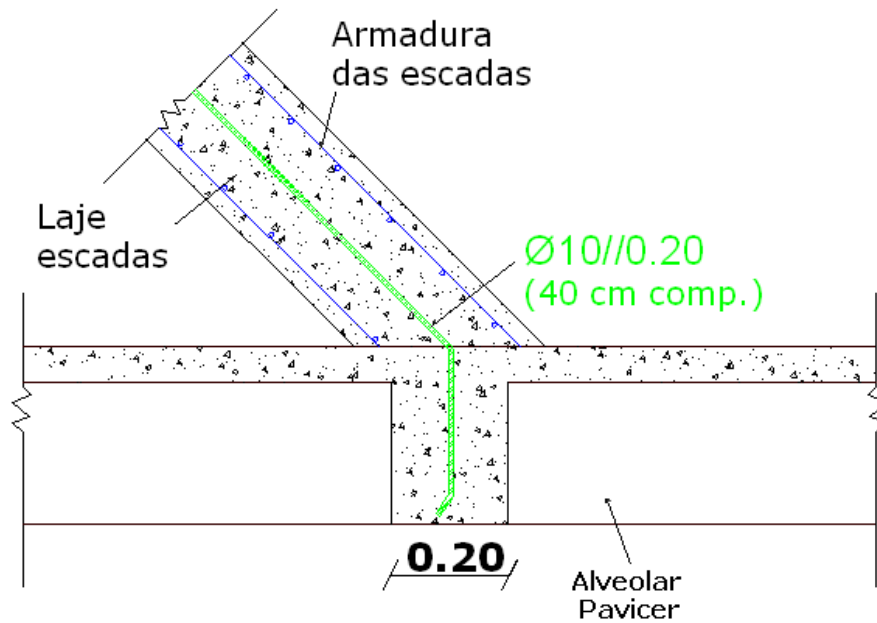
Pormenor tipo de apoio em laje de escadas – secção longitudinal.
